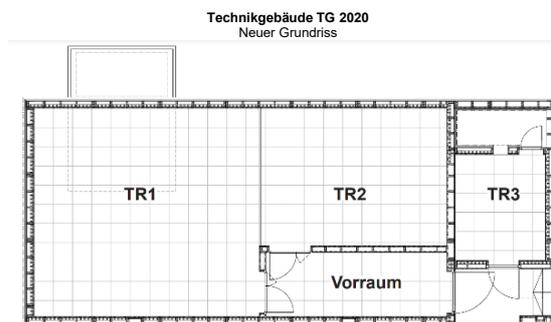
Grundriss des neuen Technikgebäudes
